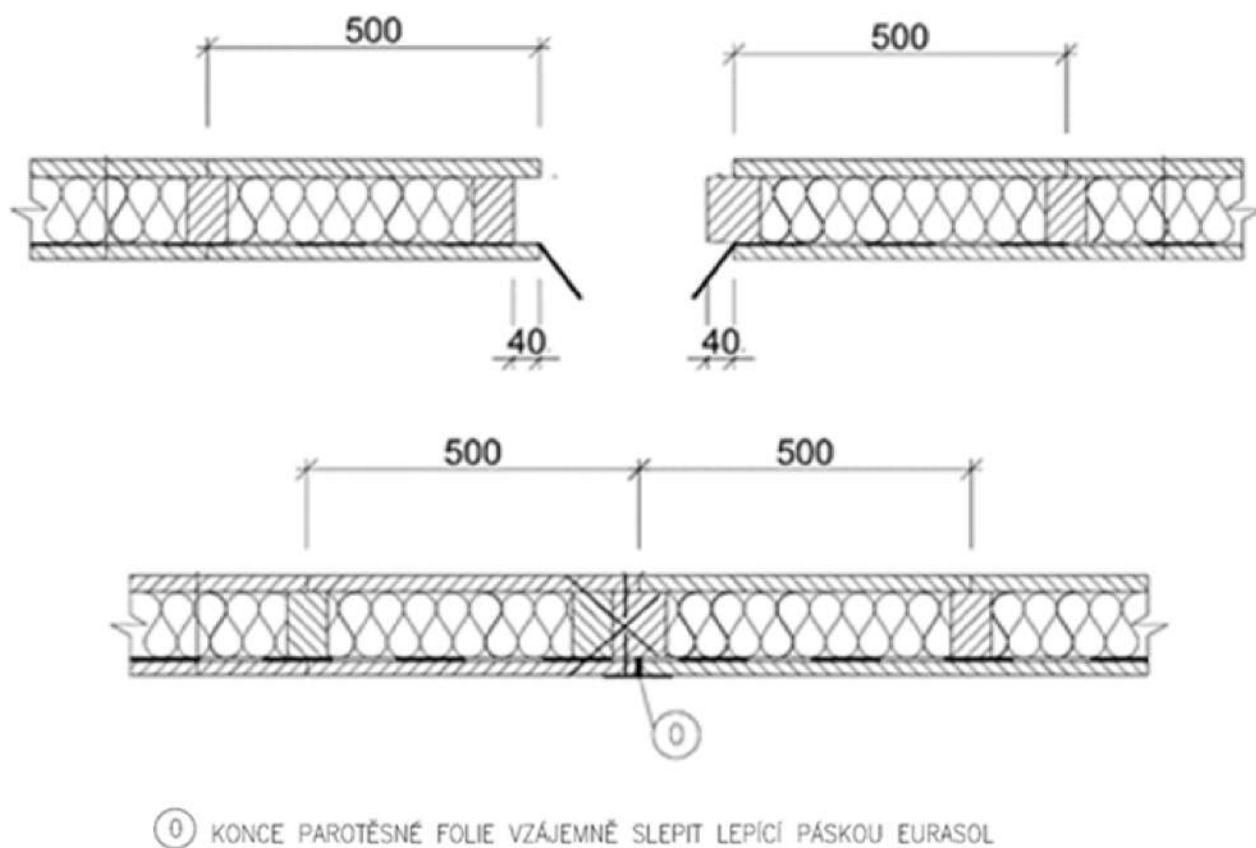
Detail provedení parotěsné folie ve styku s hydroizolací
